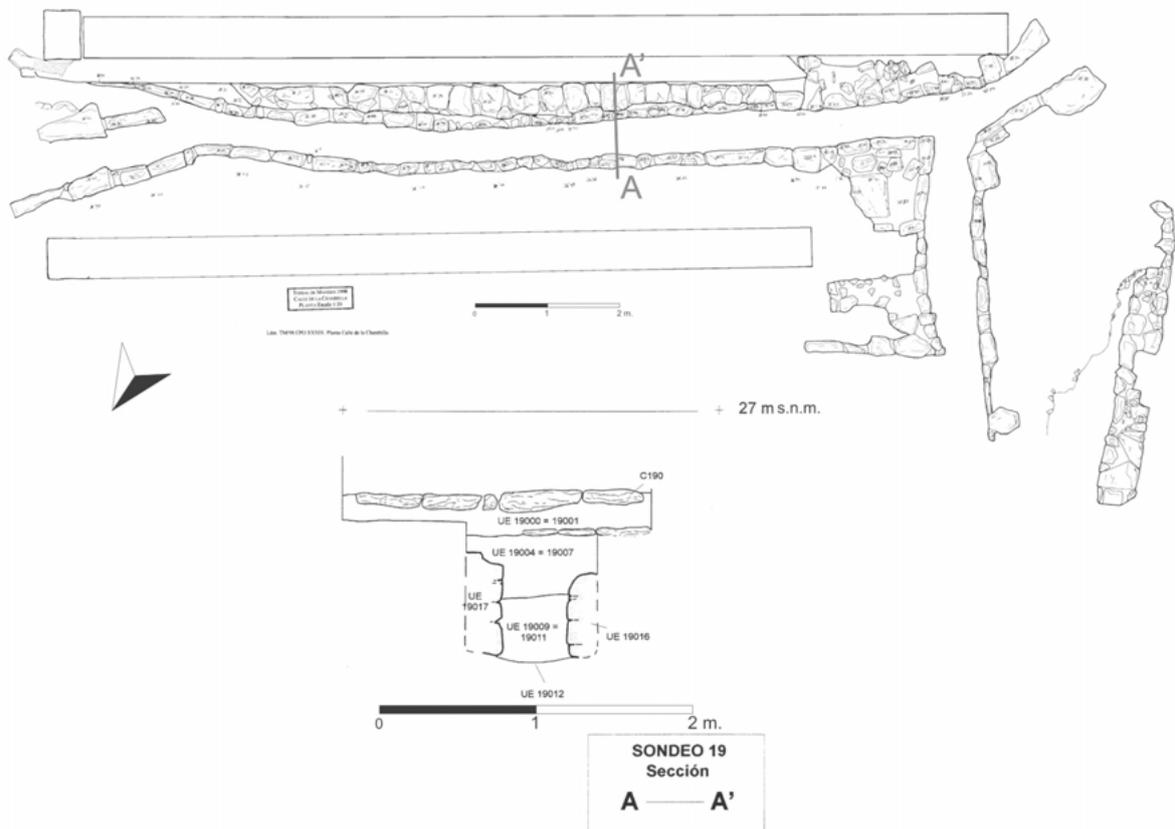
Planta y sección de la cloaca en la calle de la Chambilla (Sondeo 19).
